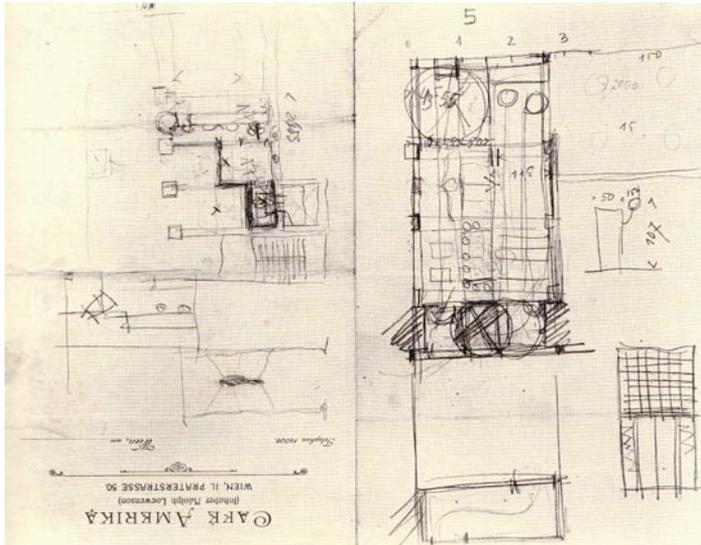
Skizzen zum zweiten Vorprojekt auf einem Rechnungszettel des Café Amerika, Bleistift. Links: Gesamtgrundriss, rechts: Grundriss mit Wendeltreppe und Drehtür (nicht ausgeführt), darunter: Windfang mit versetzten Türen, daneben: Skizze des Portals
